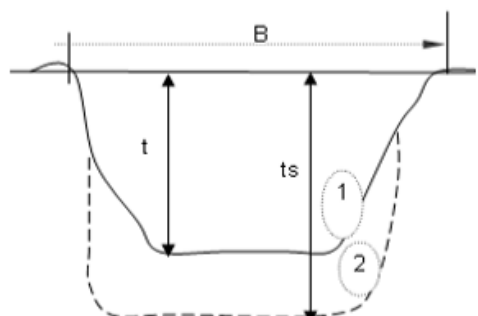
Plantilla para el cálculo de la socavación sección cantera.
